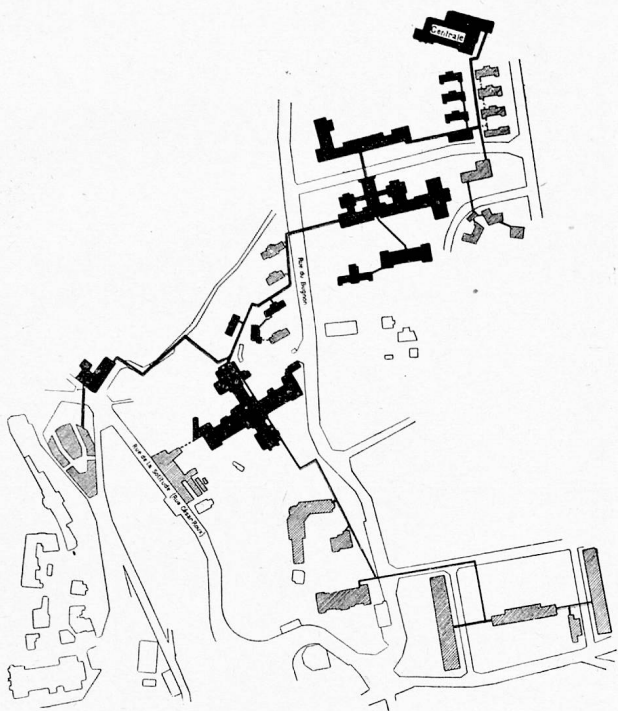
Plan de situation de la centrale de chauffage à distance de Pierre de Plan et de l'Hôpital cantonal à Lausanne. Situationsplan des Fernheizwerks Pierre de Plan und des Kantonsspitals in Lausanne.
